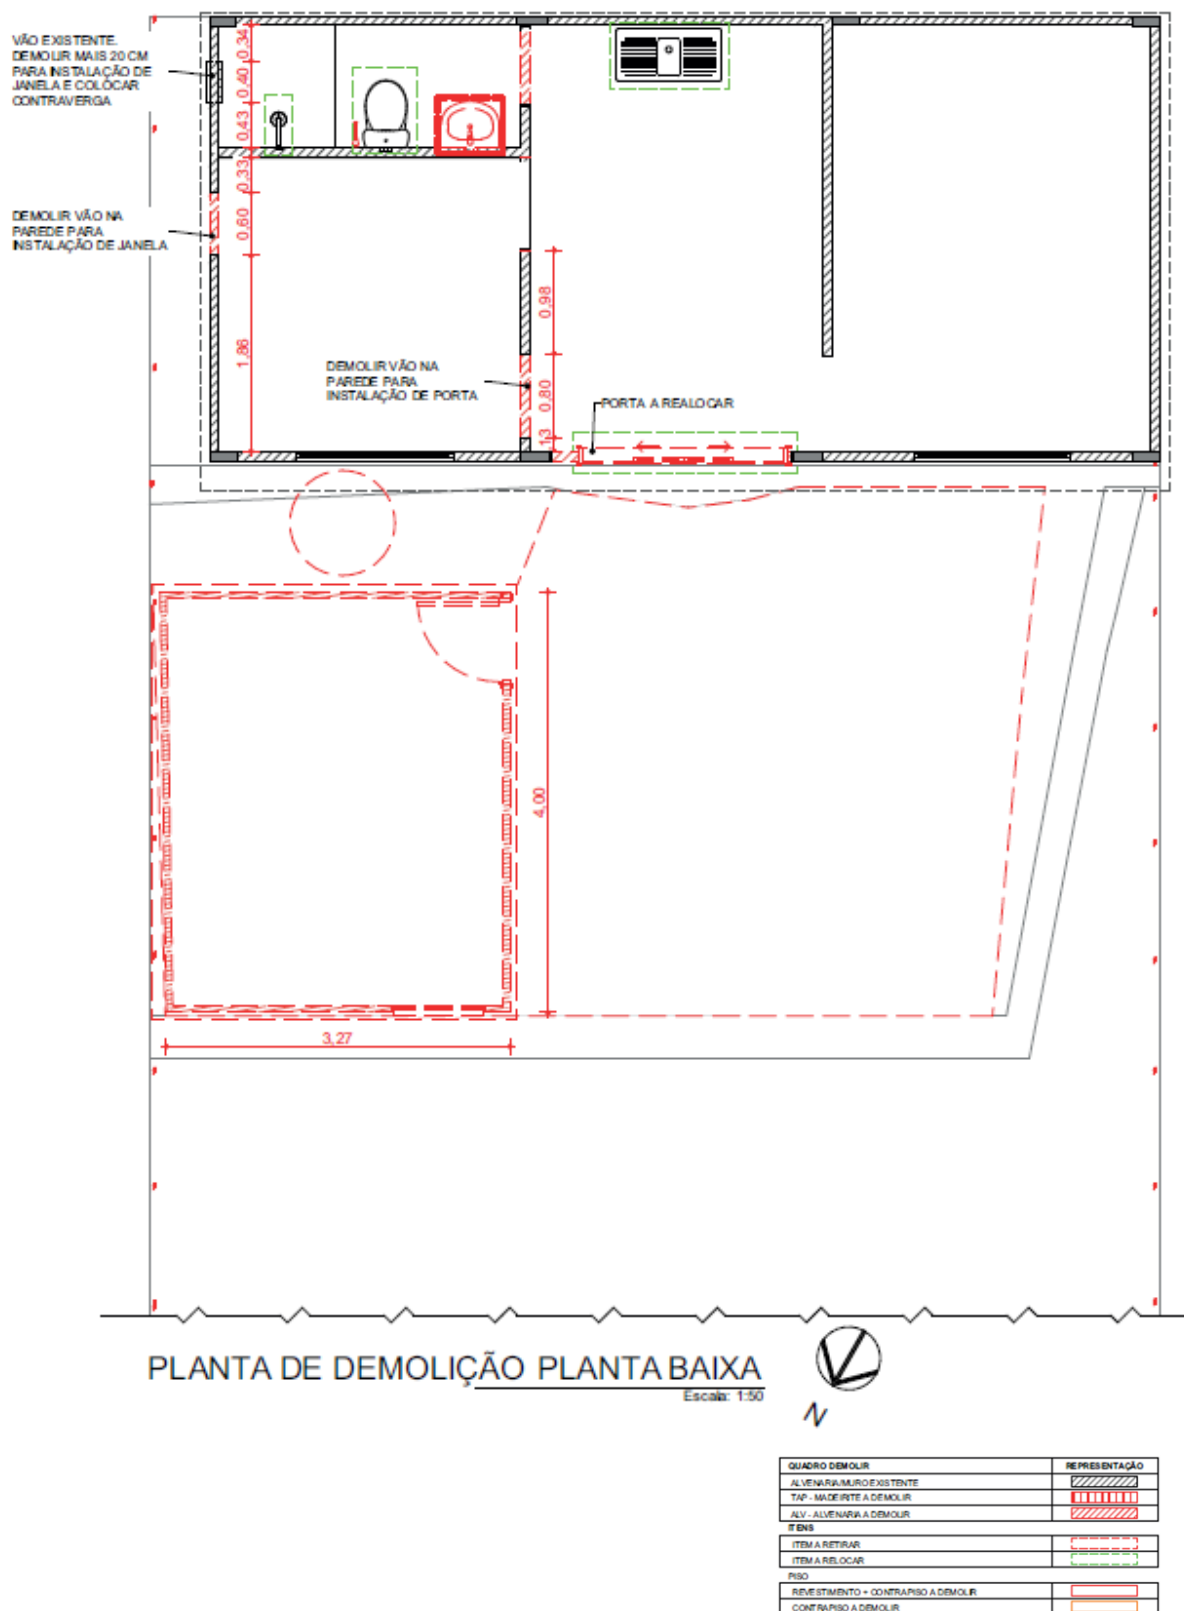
Planta com indicações de elementos a demolir da ATMH-3
